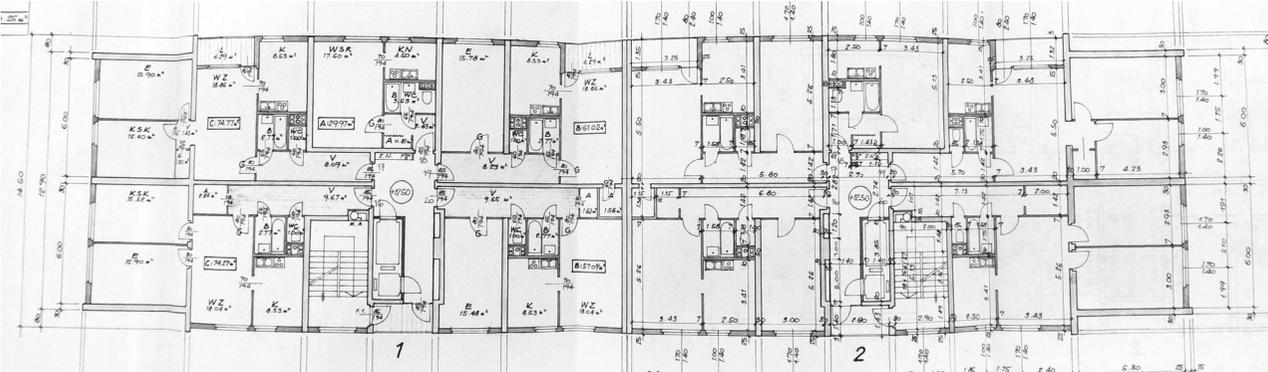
Grundriss Regelgeschoß Einreichung Nr. 32
